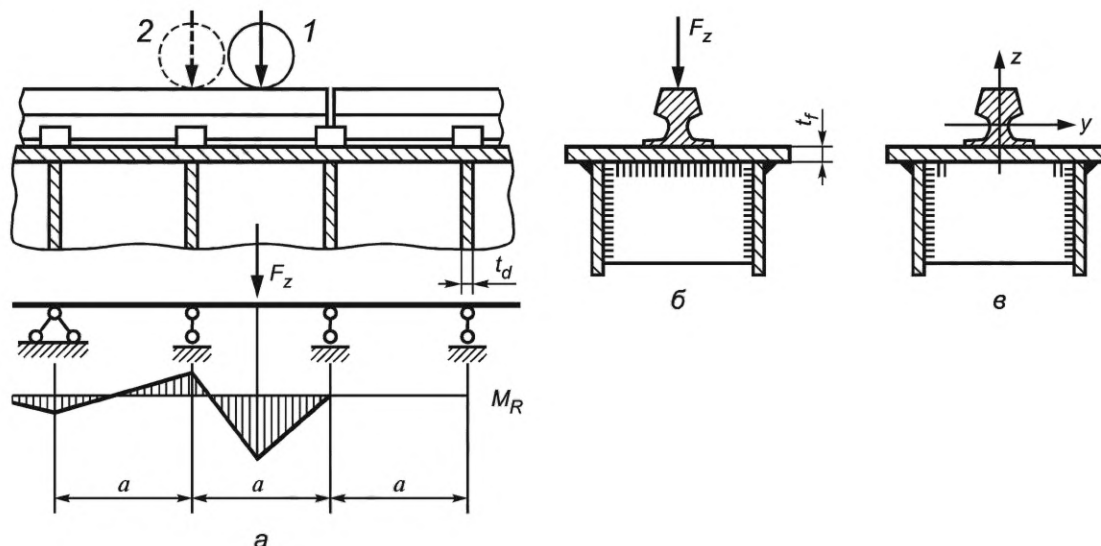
Схемы к расчету ездовой балки с рельсом между стенками
